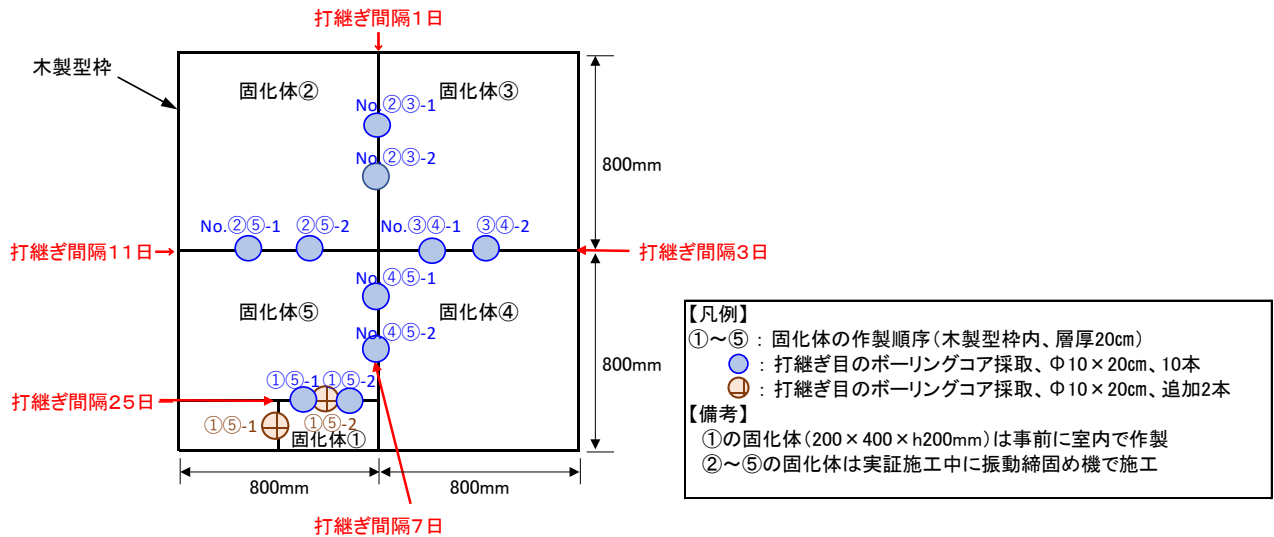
鉛直打継目の密着性確認実験の概要（平面図、施工順序）
